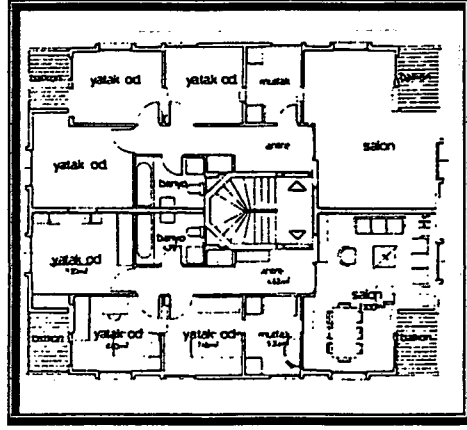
Düz kollu dikdörtgen basamaklı tek kollu merdiven (çift daire planı)
